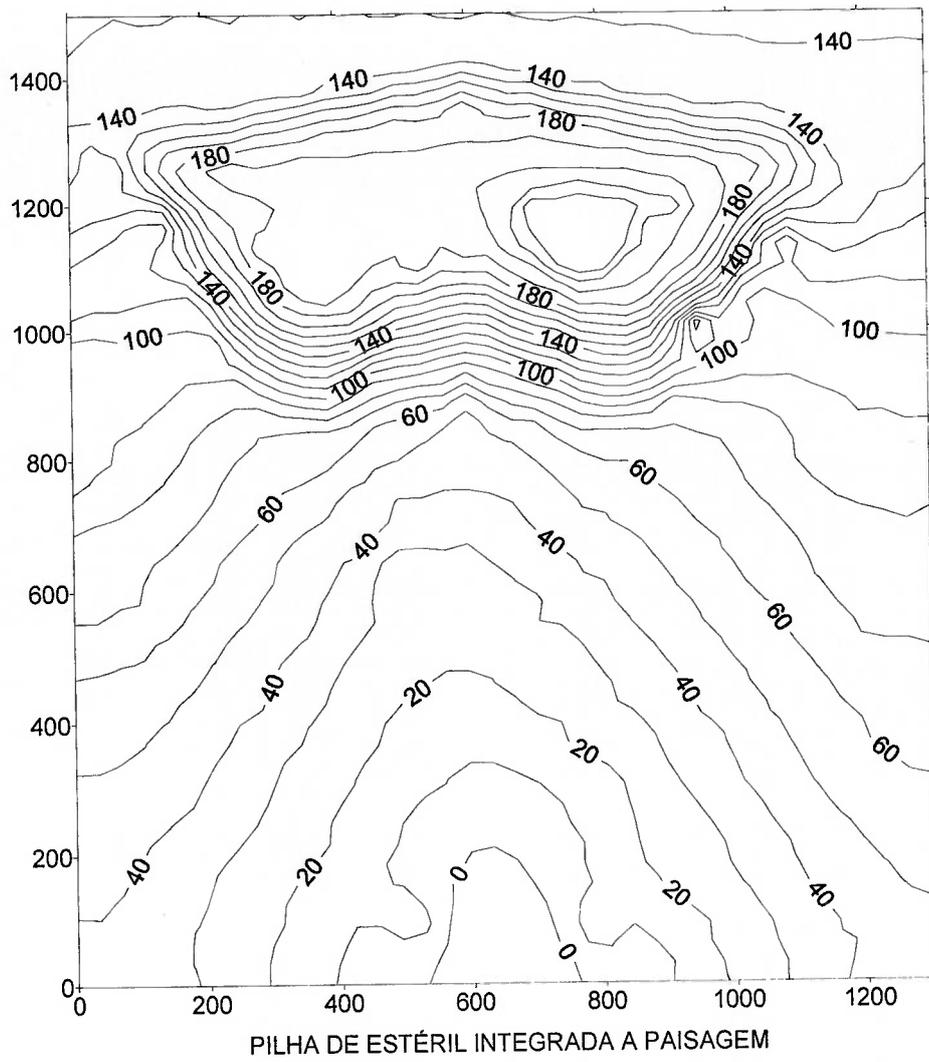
Planta planialtimétrica de pilha de estéril otimizada
